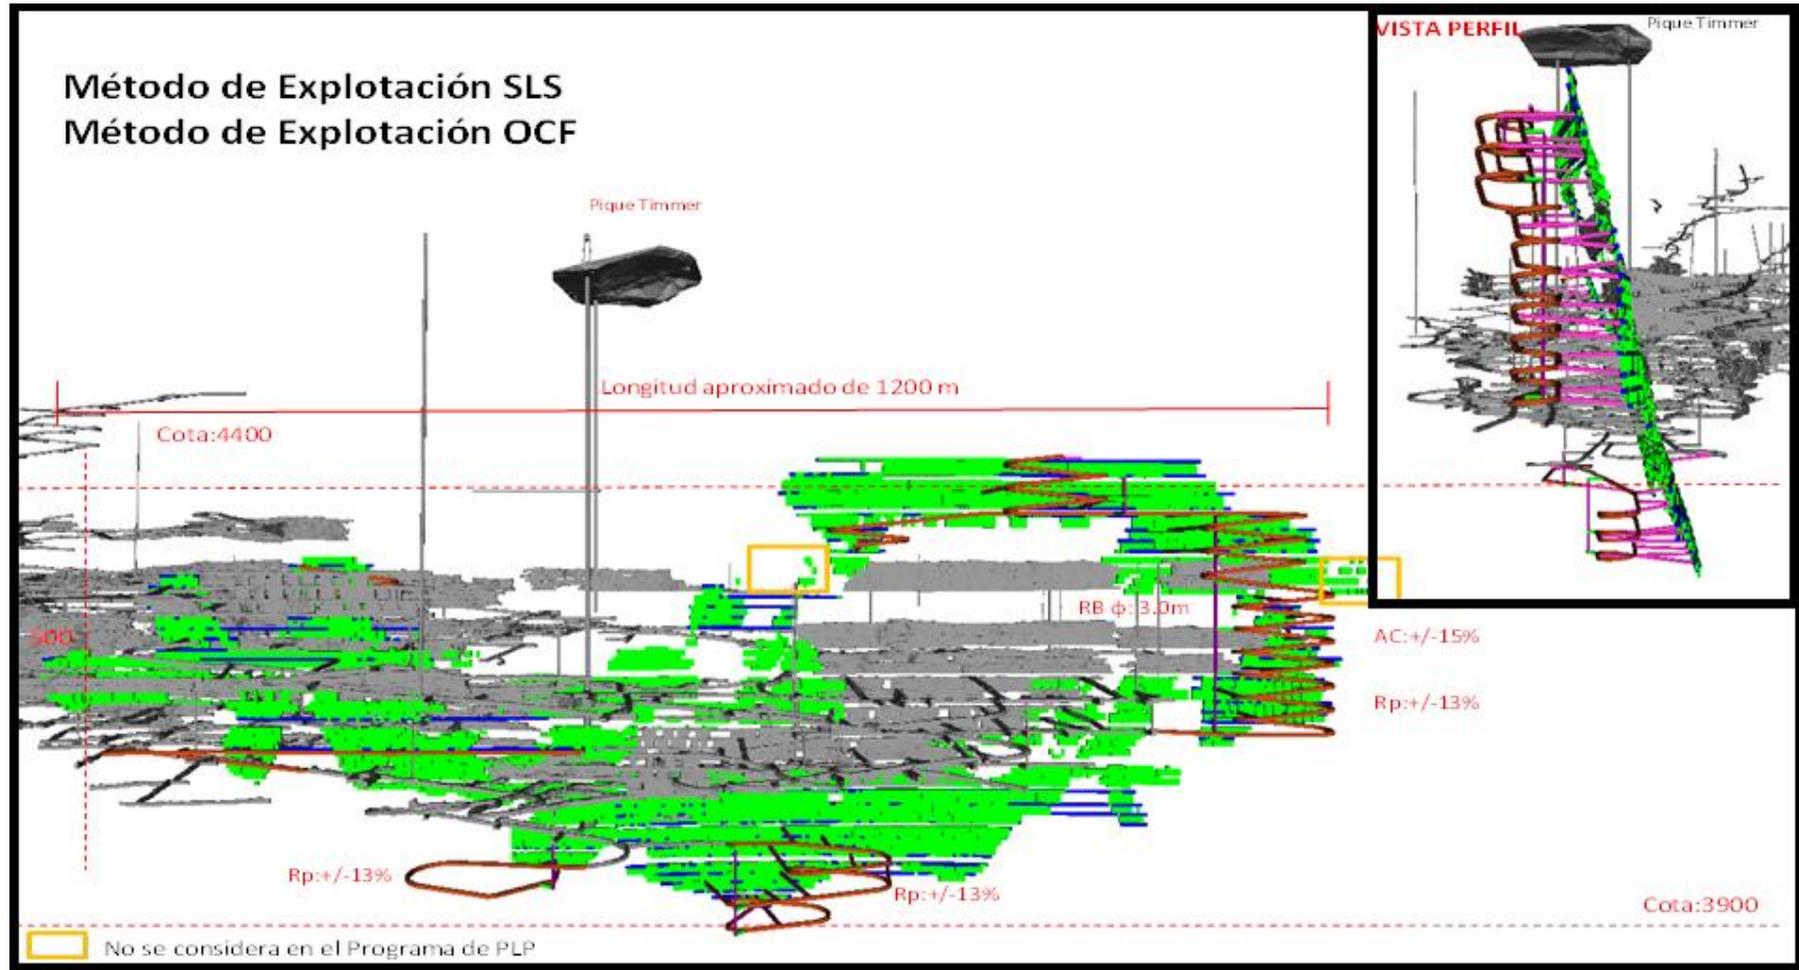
Infraestructura Veta Karina perfil longitudinal- Planeamiento Animon
